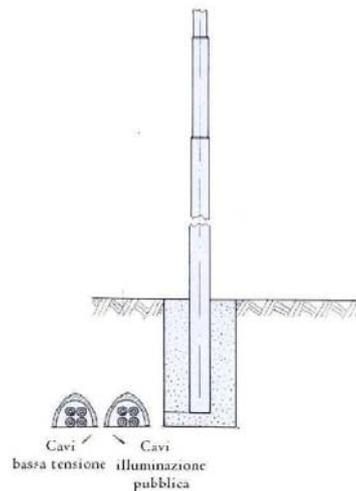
Impianto con linea di alimentazione propria e indipendente dalla rete di bassa tensione
